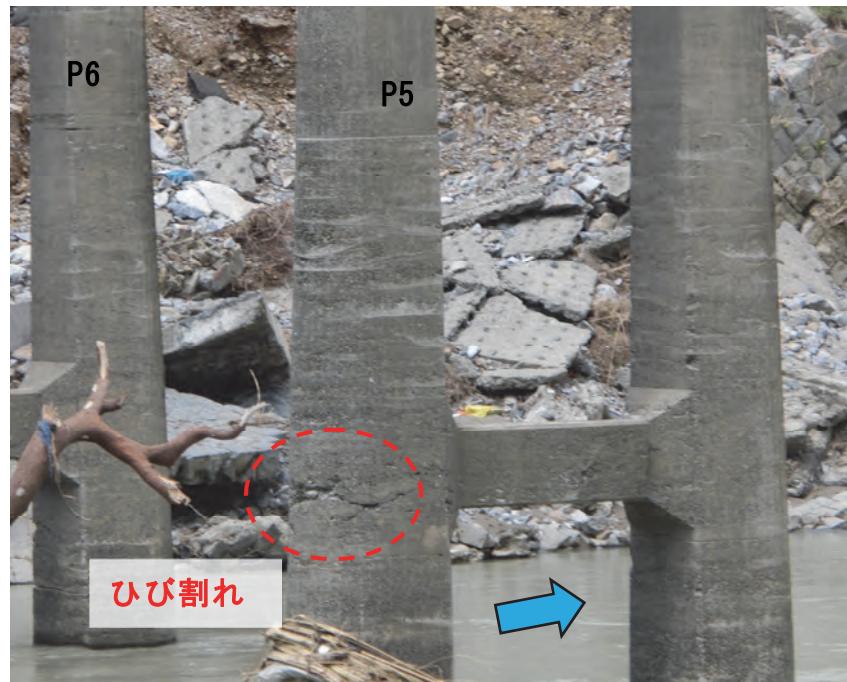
P5 橋脚中間梁付近のひび割れ
